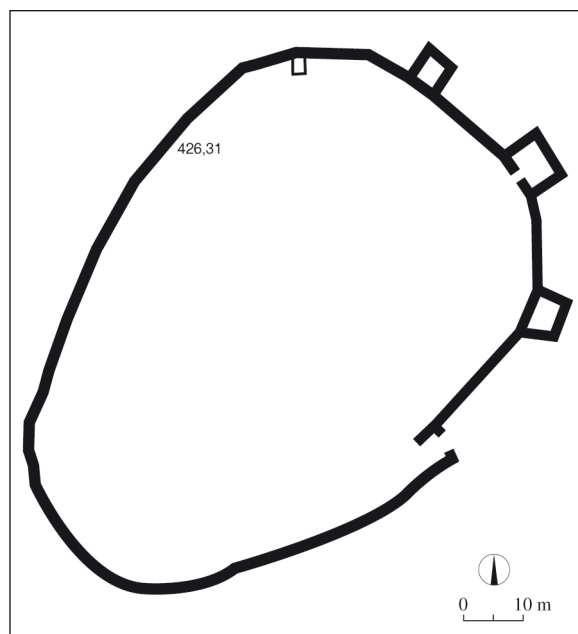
Cer-Konjuša. Grundriss (nach Milinković 2011, Abb. 4/5).
